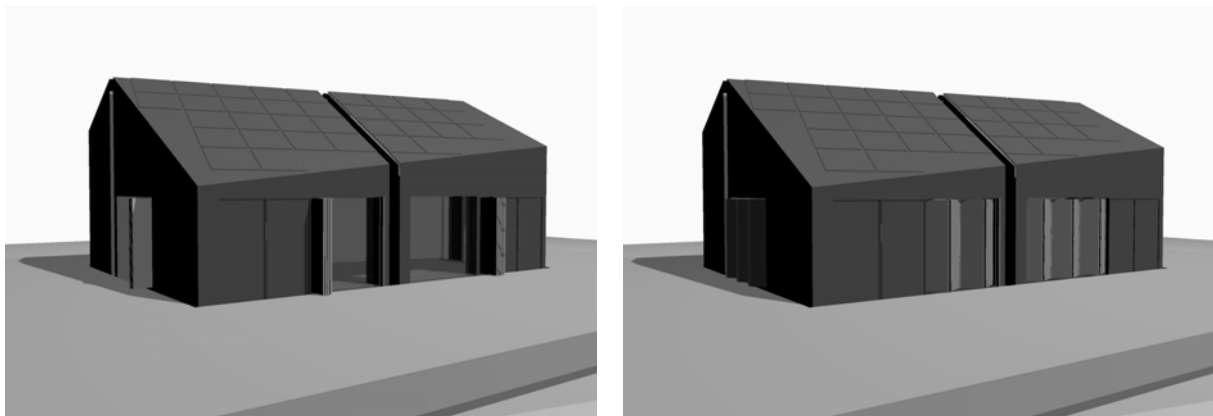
Rendering mit offenem und geschlossenem Lamellensystem
